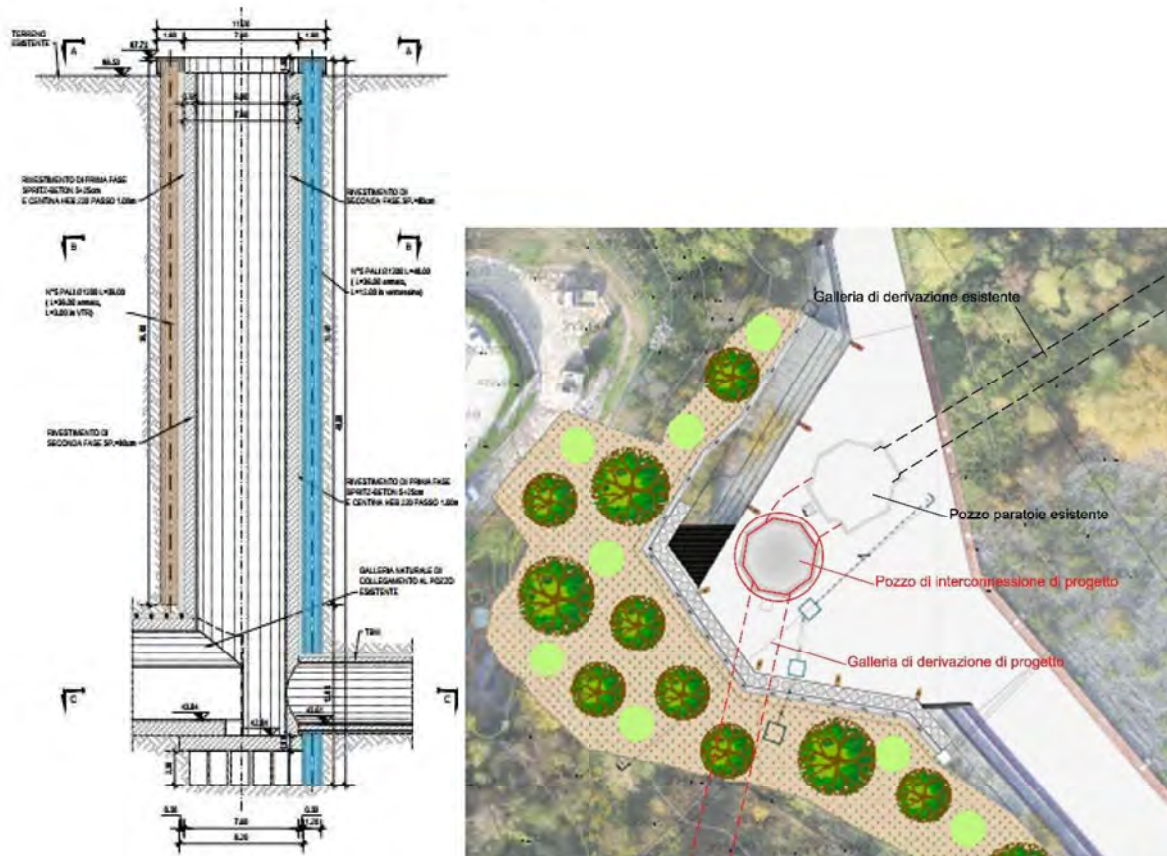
Pozzo di ispezione e di collegamento con opere di presa
